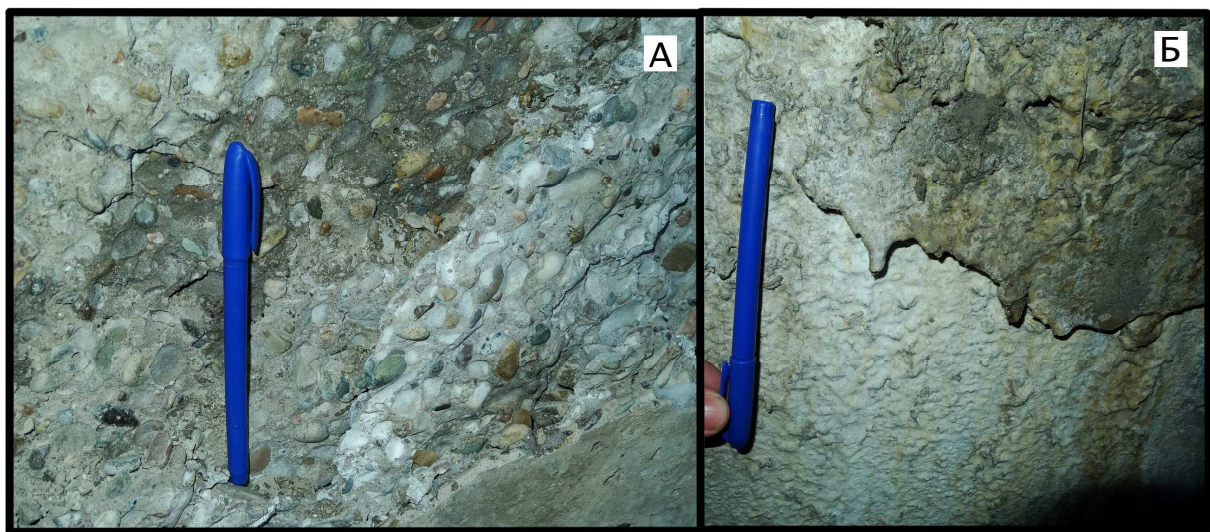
а – сеть трещин в бетонных блоках и расслаивание бетона по крупным трещинам, б – сталактиты, выросшие в трещине в стене.
